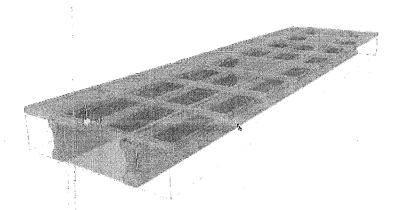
Vista en 3D, de la seccion de la losa que hace parte de la estructura del puente. Fuente: DISEÑO ESTRUTURAL<sup>16</sup>.
